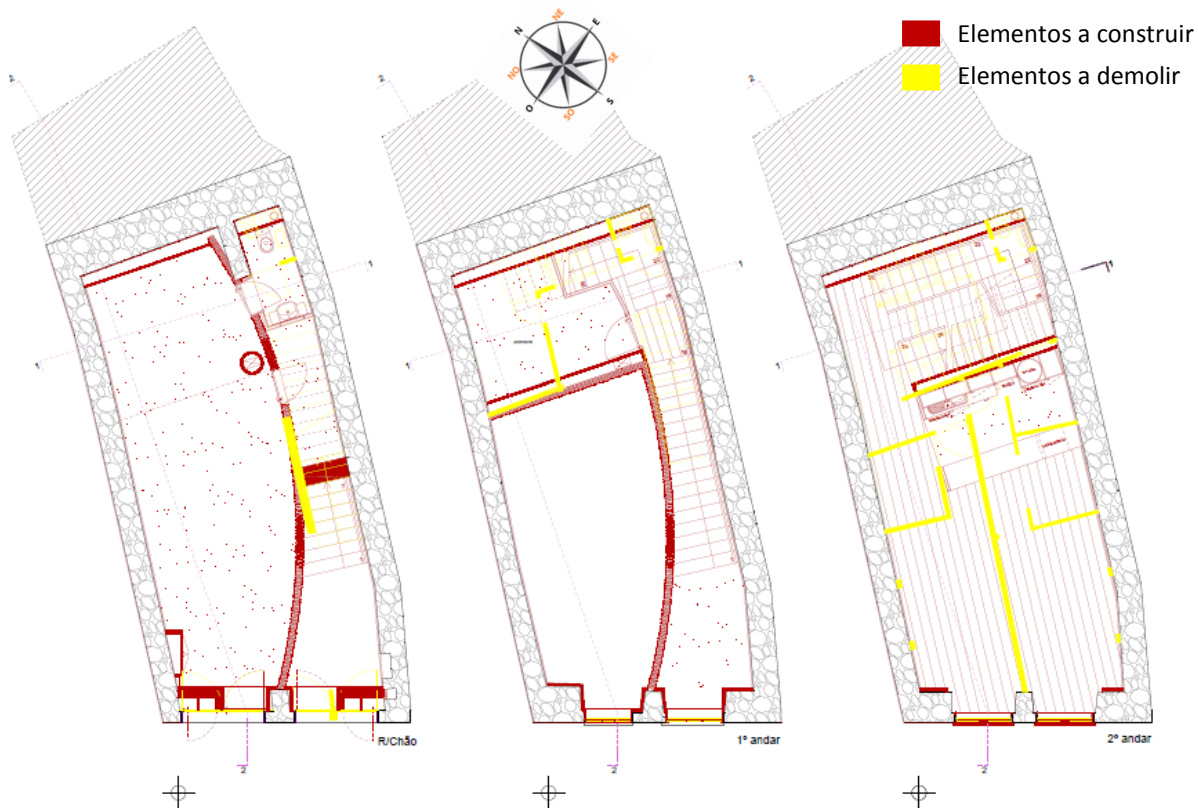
Plantas do R/C, 1º e 2º piso [17]
